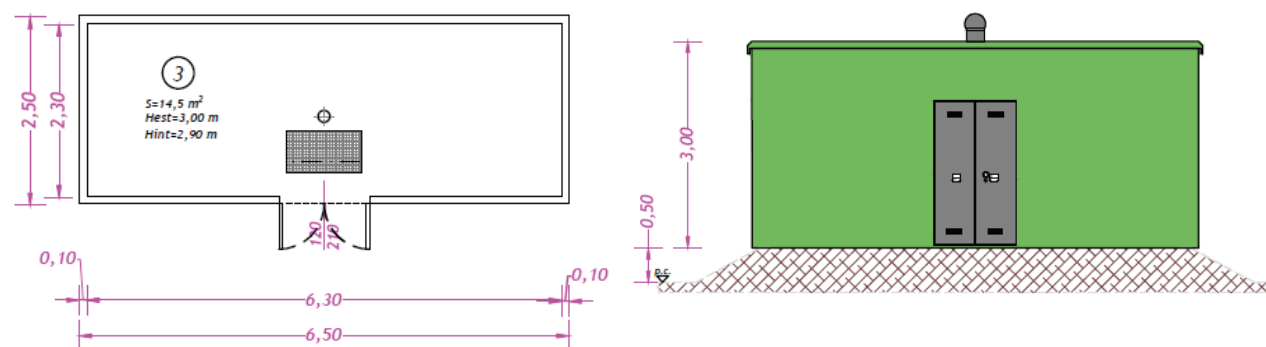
Pianta e profilo delle cabine MT Utente
